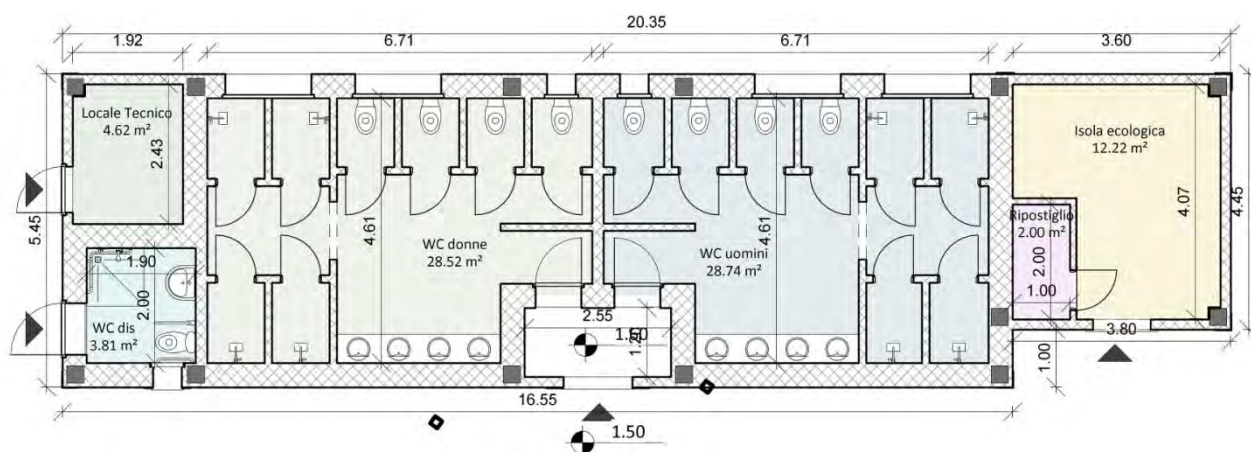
Servizi igienici adiacenti Club House pianta piano terra
